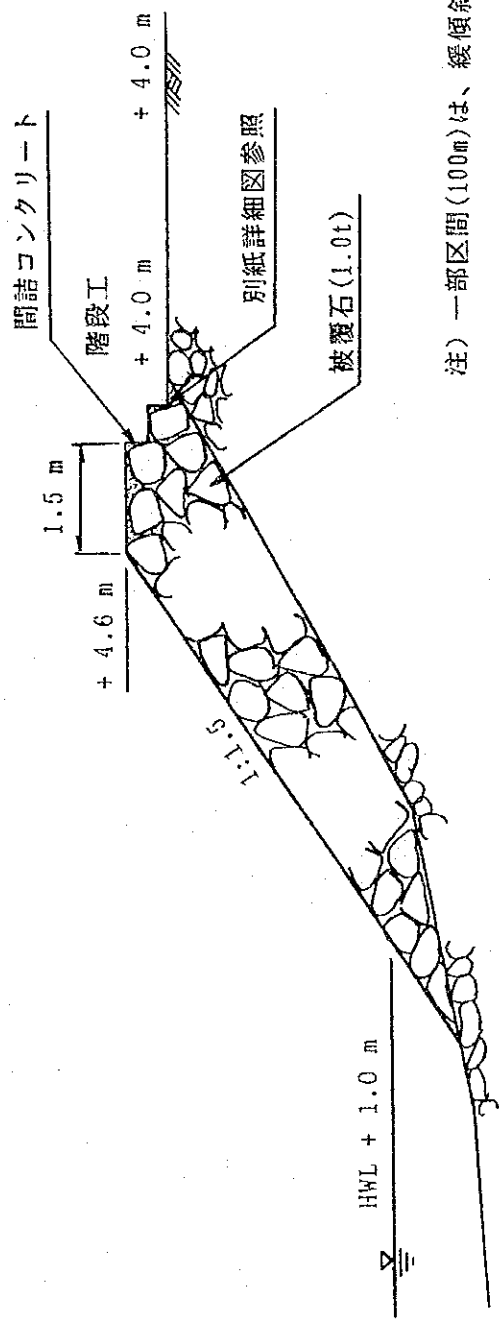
海岸保全施設、標準断面図 (B - C 区間)
